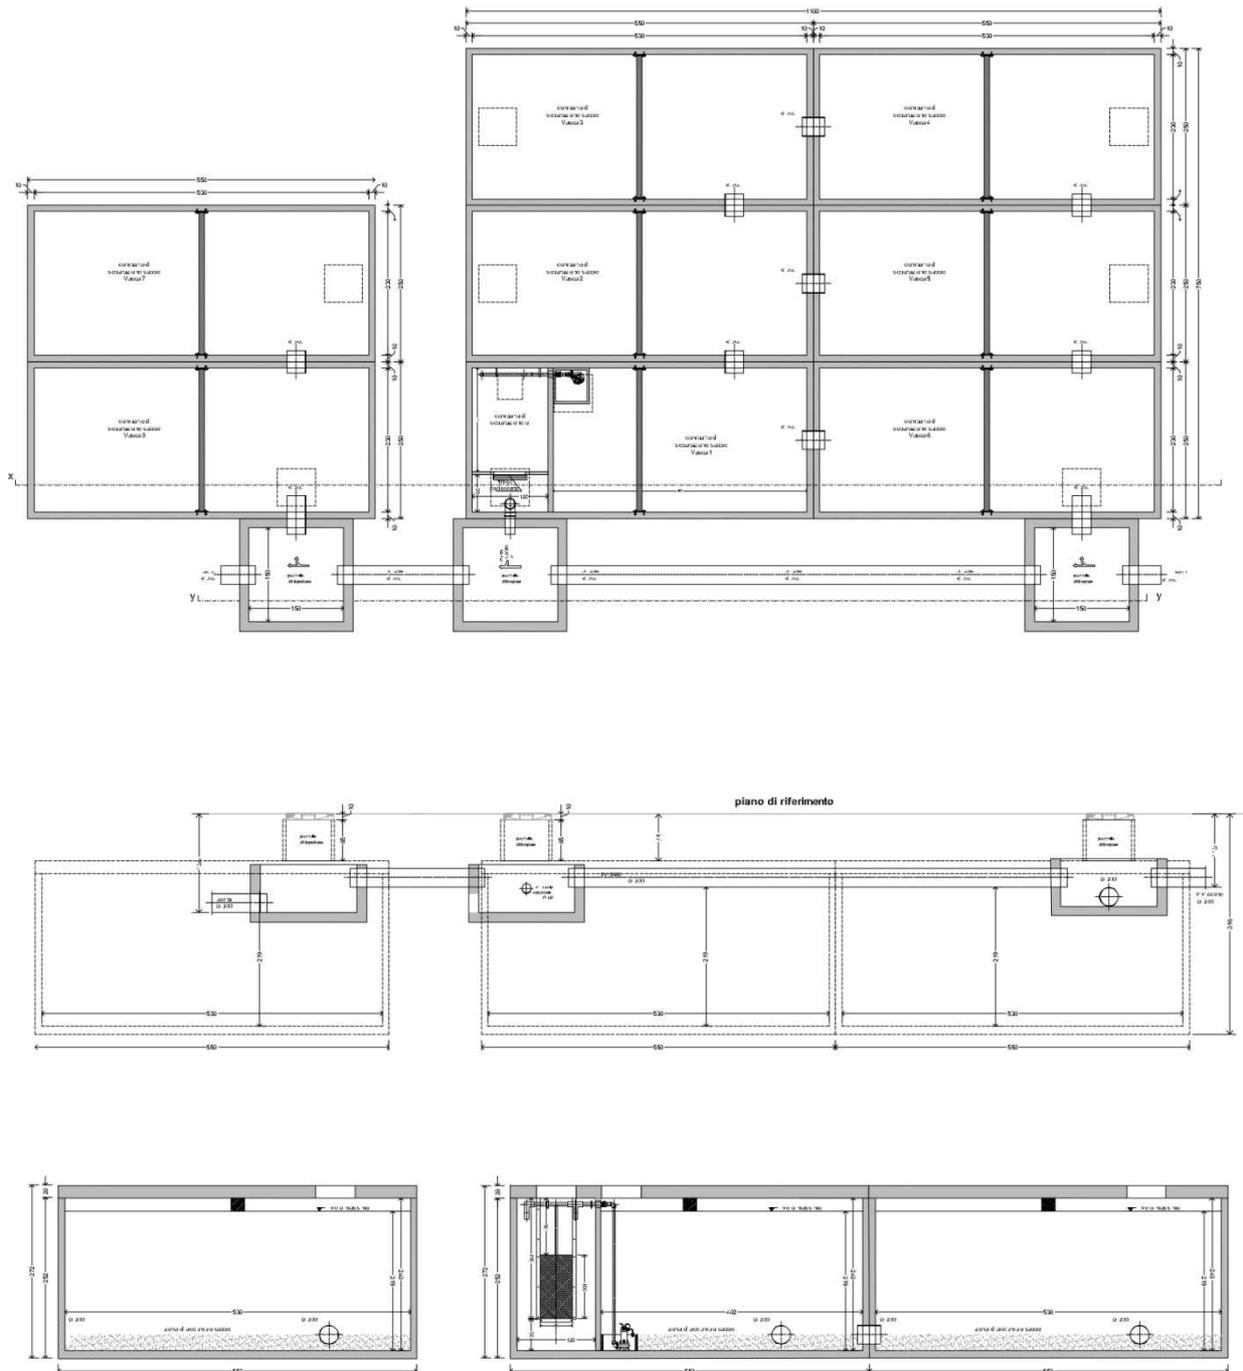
Vasche di accumulo. Pianta, Sezione x-x, Sezione y-y
